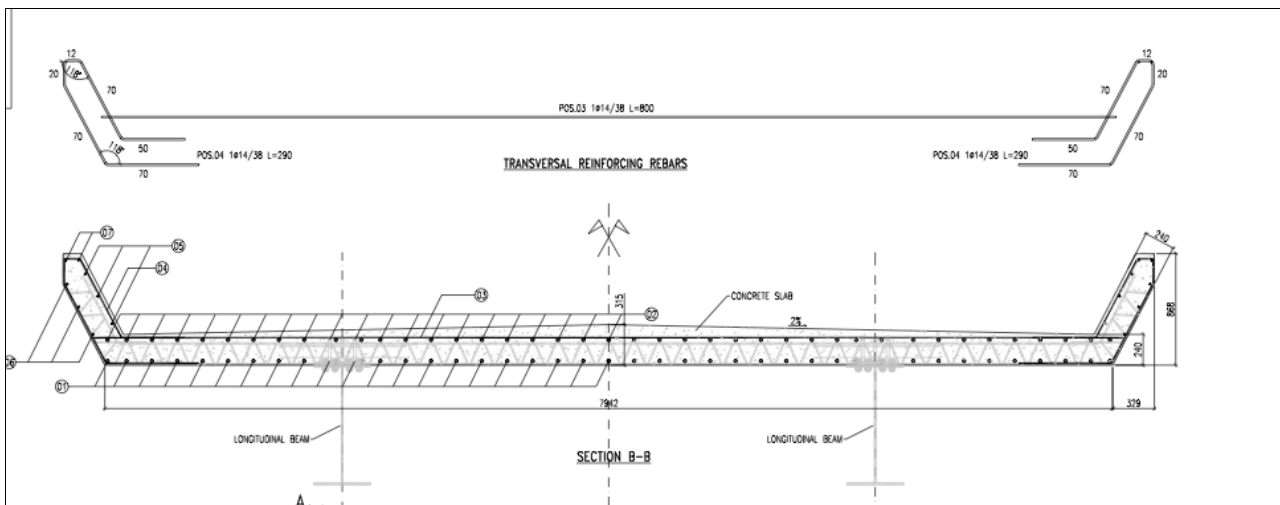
Exemplu de tablier cu cuvă din beton cu esafodaj metalic pierdut
